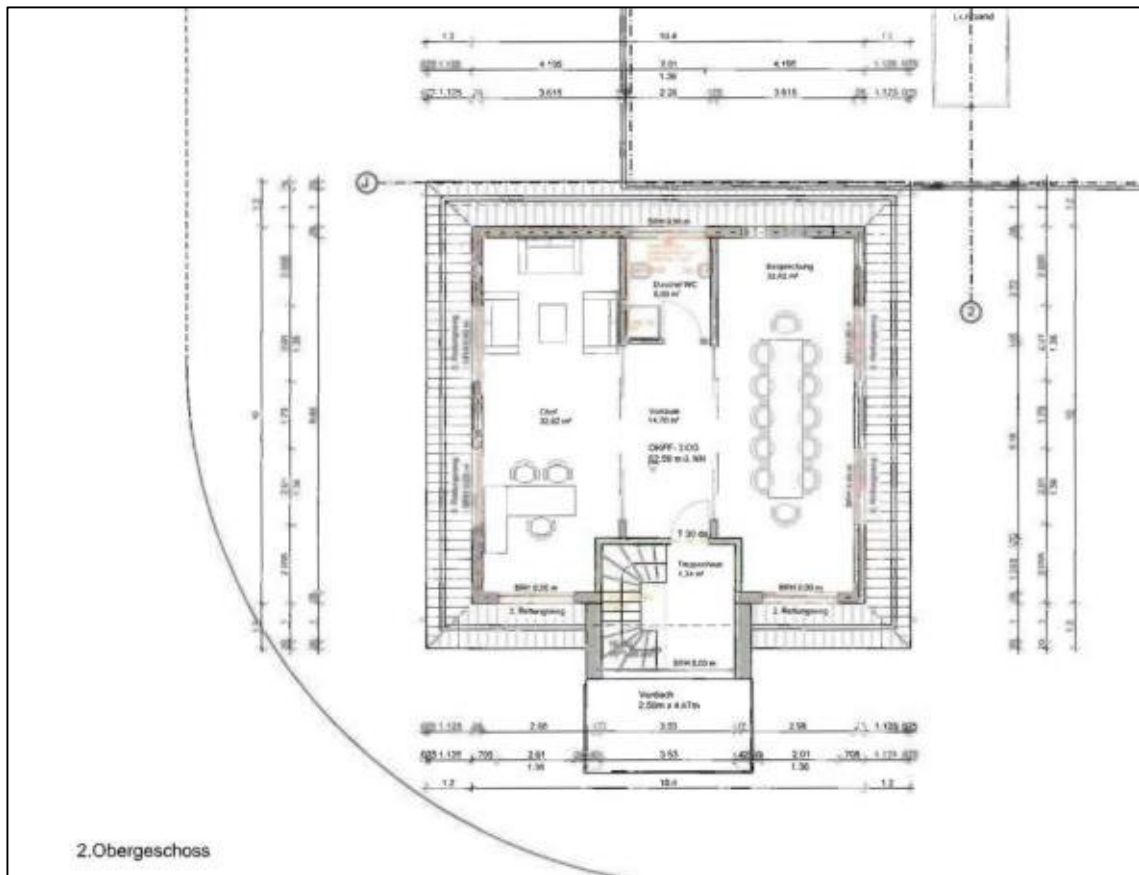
2. Obergeschoss-Grundriss vom Verwaltungsgebäude
